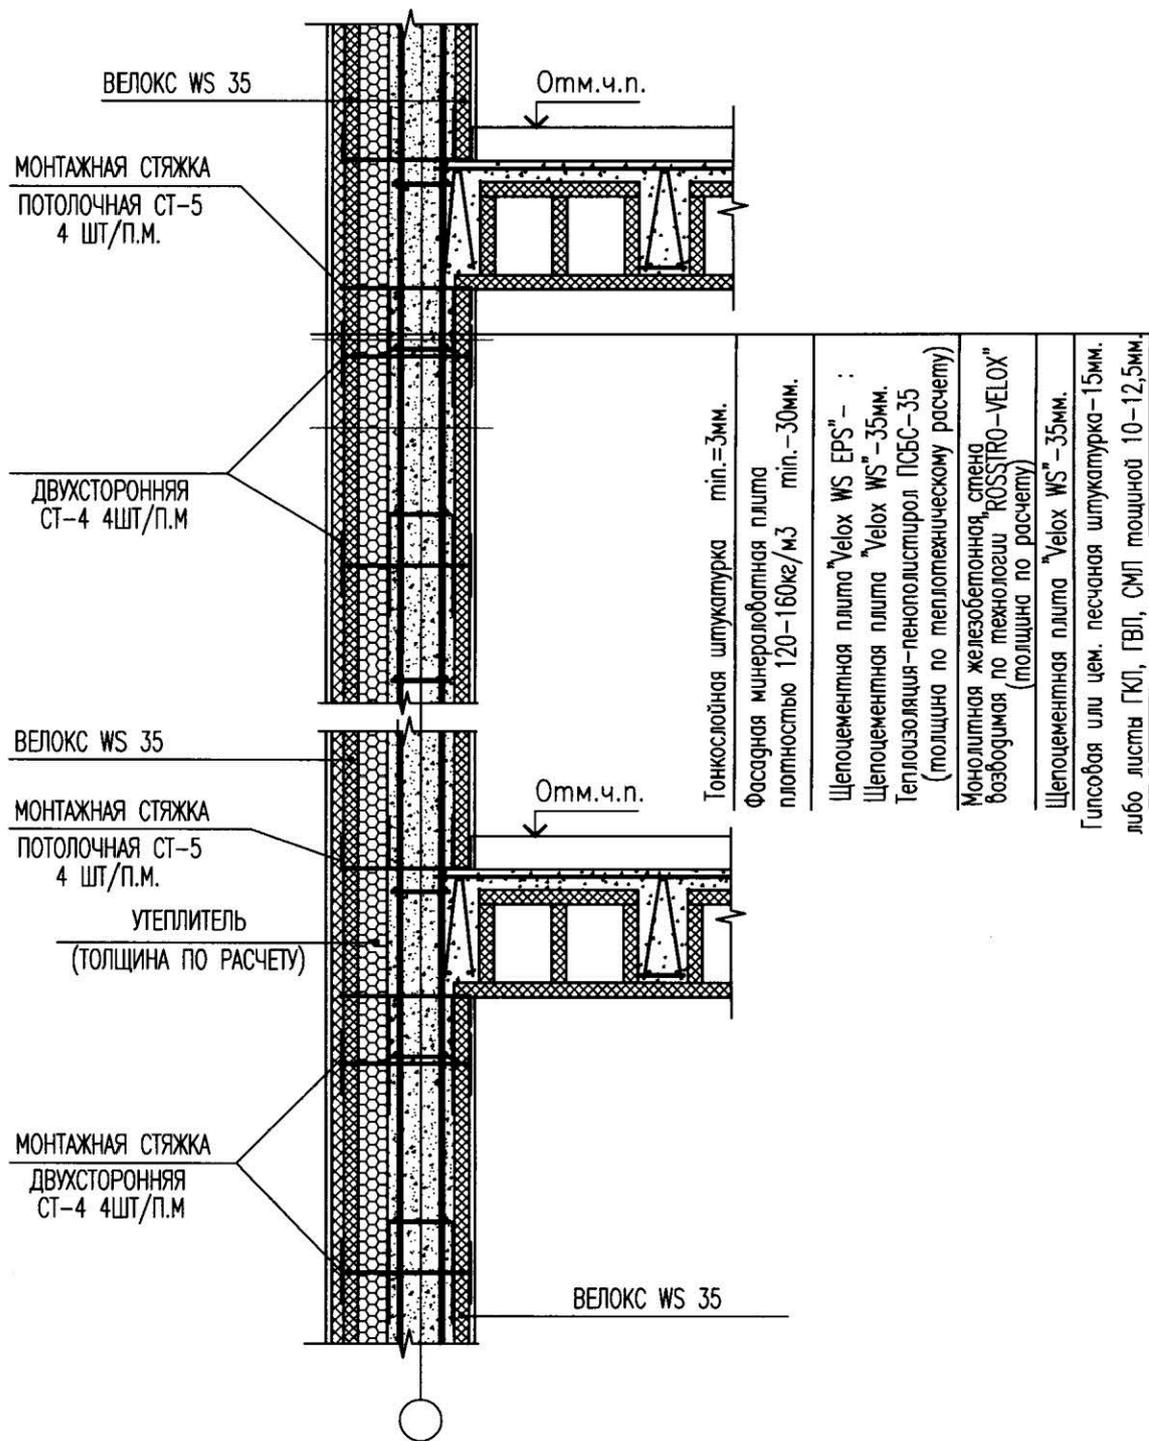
Схема конструктивного исполнения наружной несущей железобетонной стены, возводимой по технологии несъемной опалубки "ROSSSTRO-VELOX", с дополнительным слоем минераловатного утеплителя
